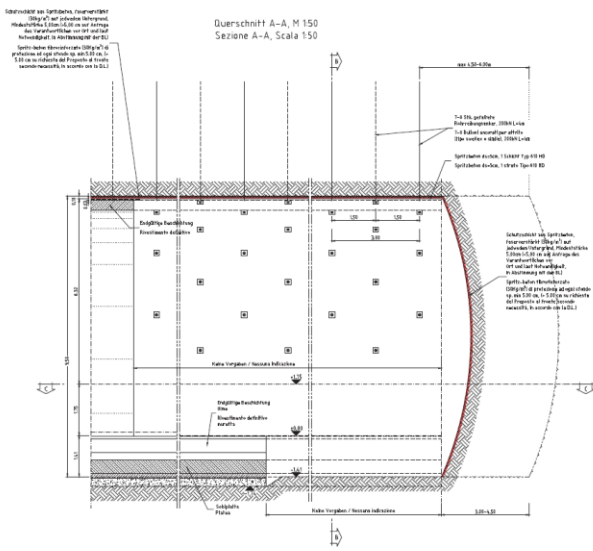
Scavo e sostegni - sezione tipo A1.
